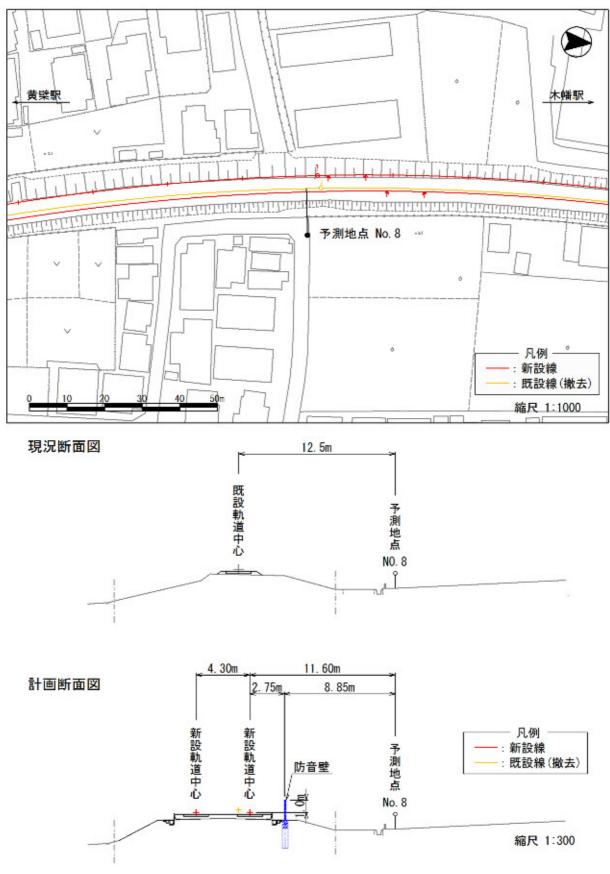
(8) 予測平面·断面図(予測地点 No.8)
